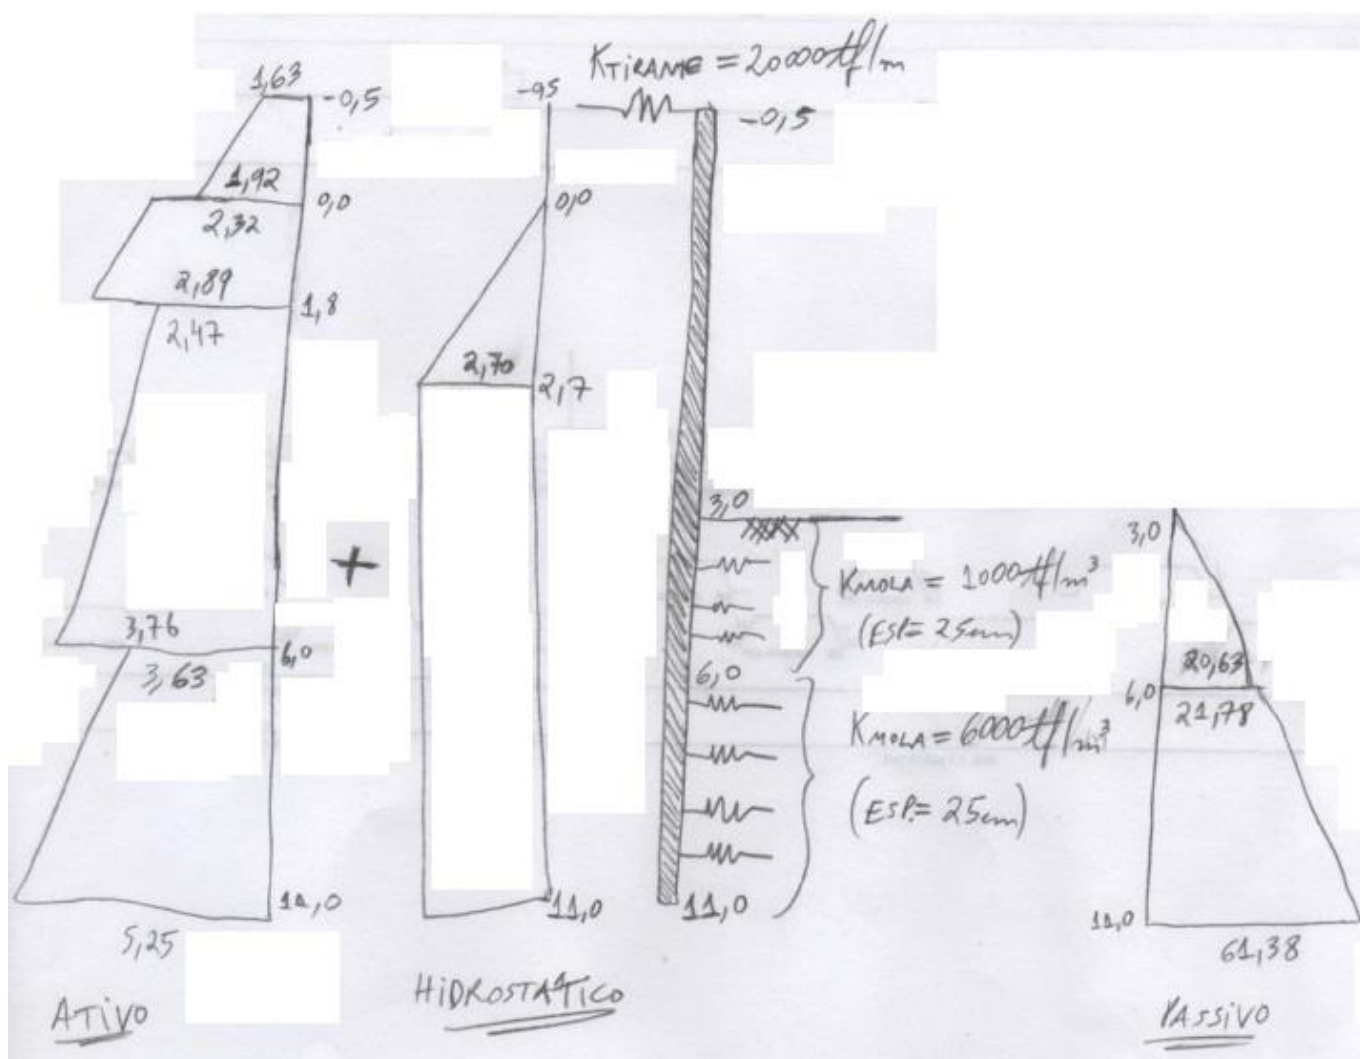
Croqui do modelo estrutural e dos carregamentos (tensões em tf/m^2 e medidas em metros).
